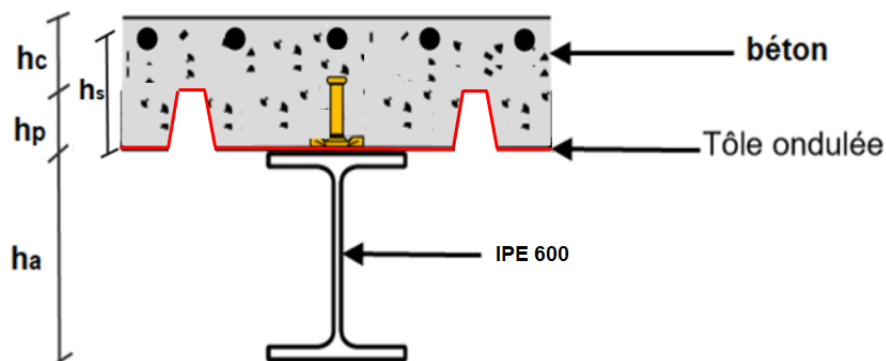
poutre mixte avec nervures parallèle à l'axe du profile
